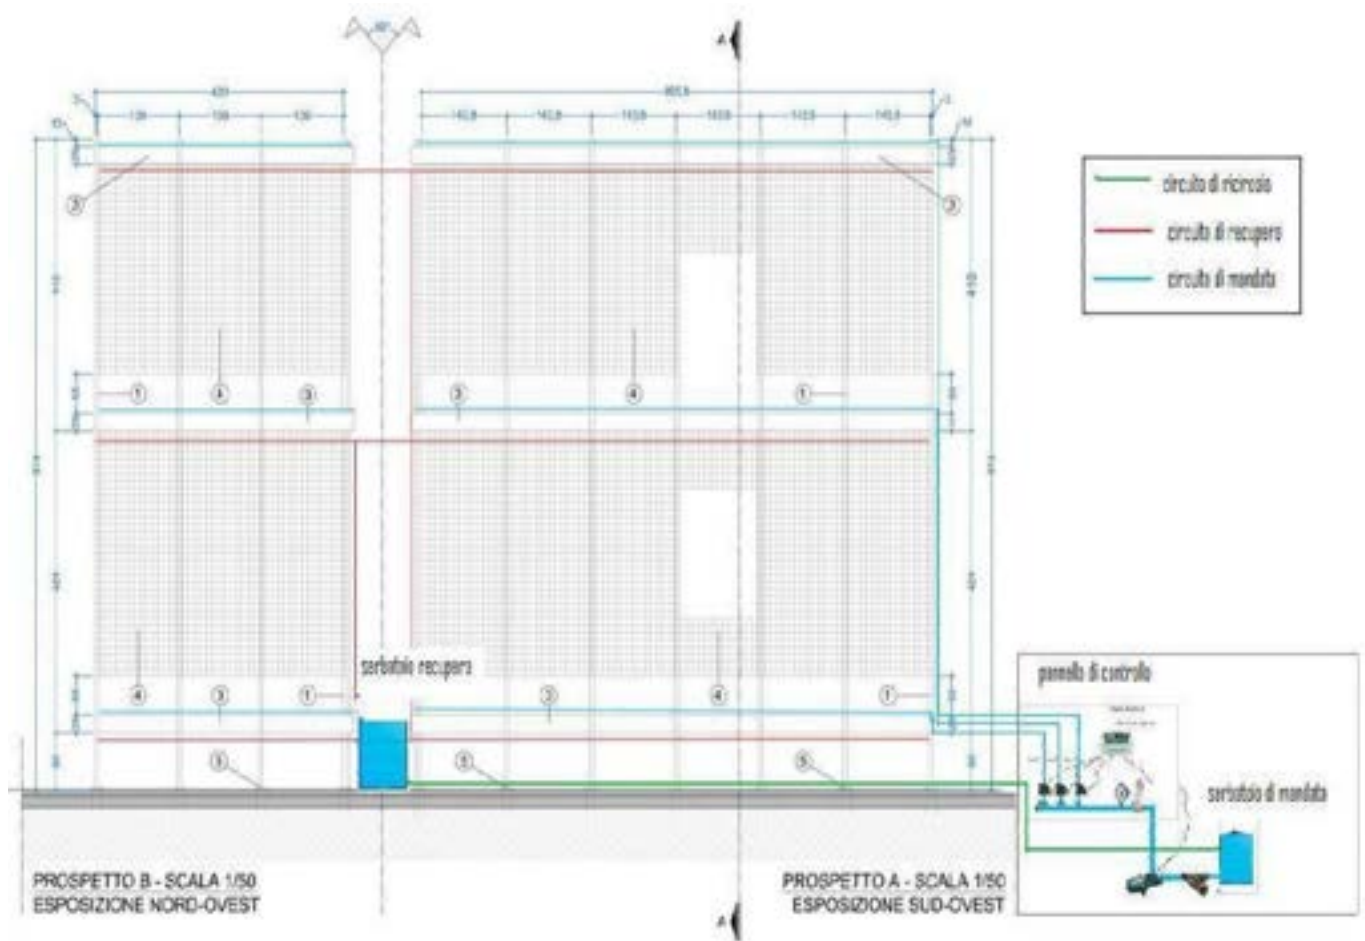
Lay-out del sistema di fertirrigazione installato alla parete verde
